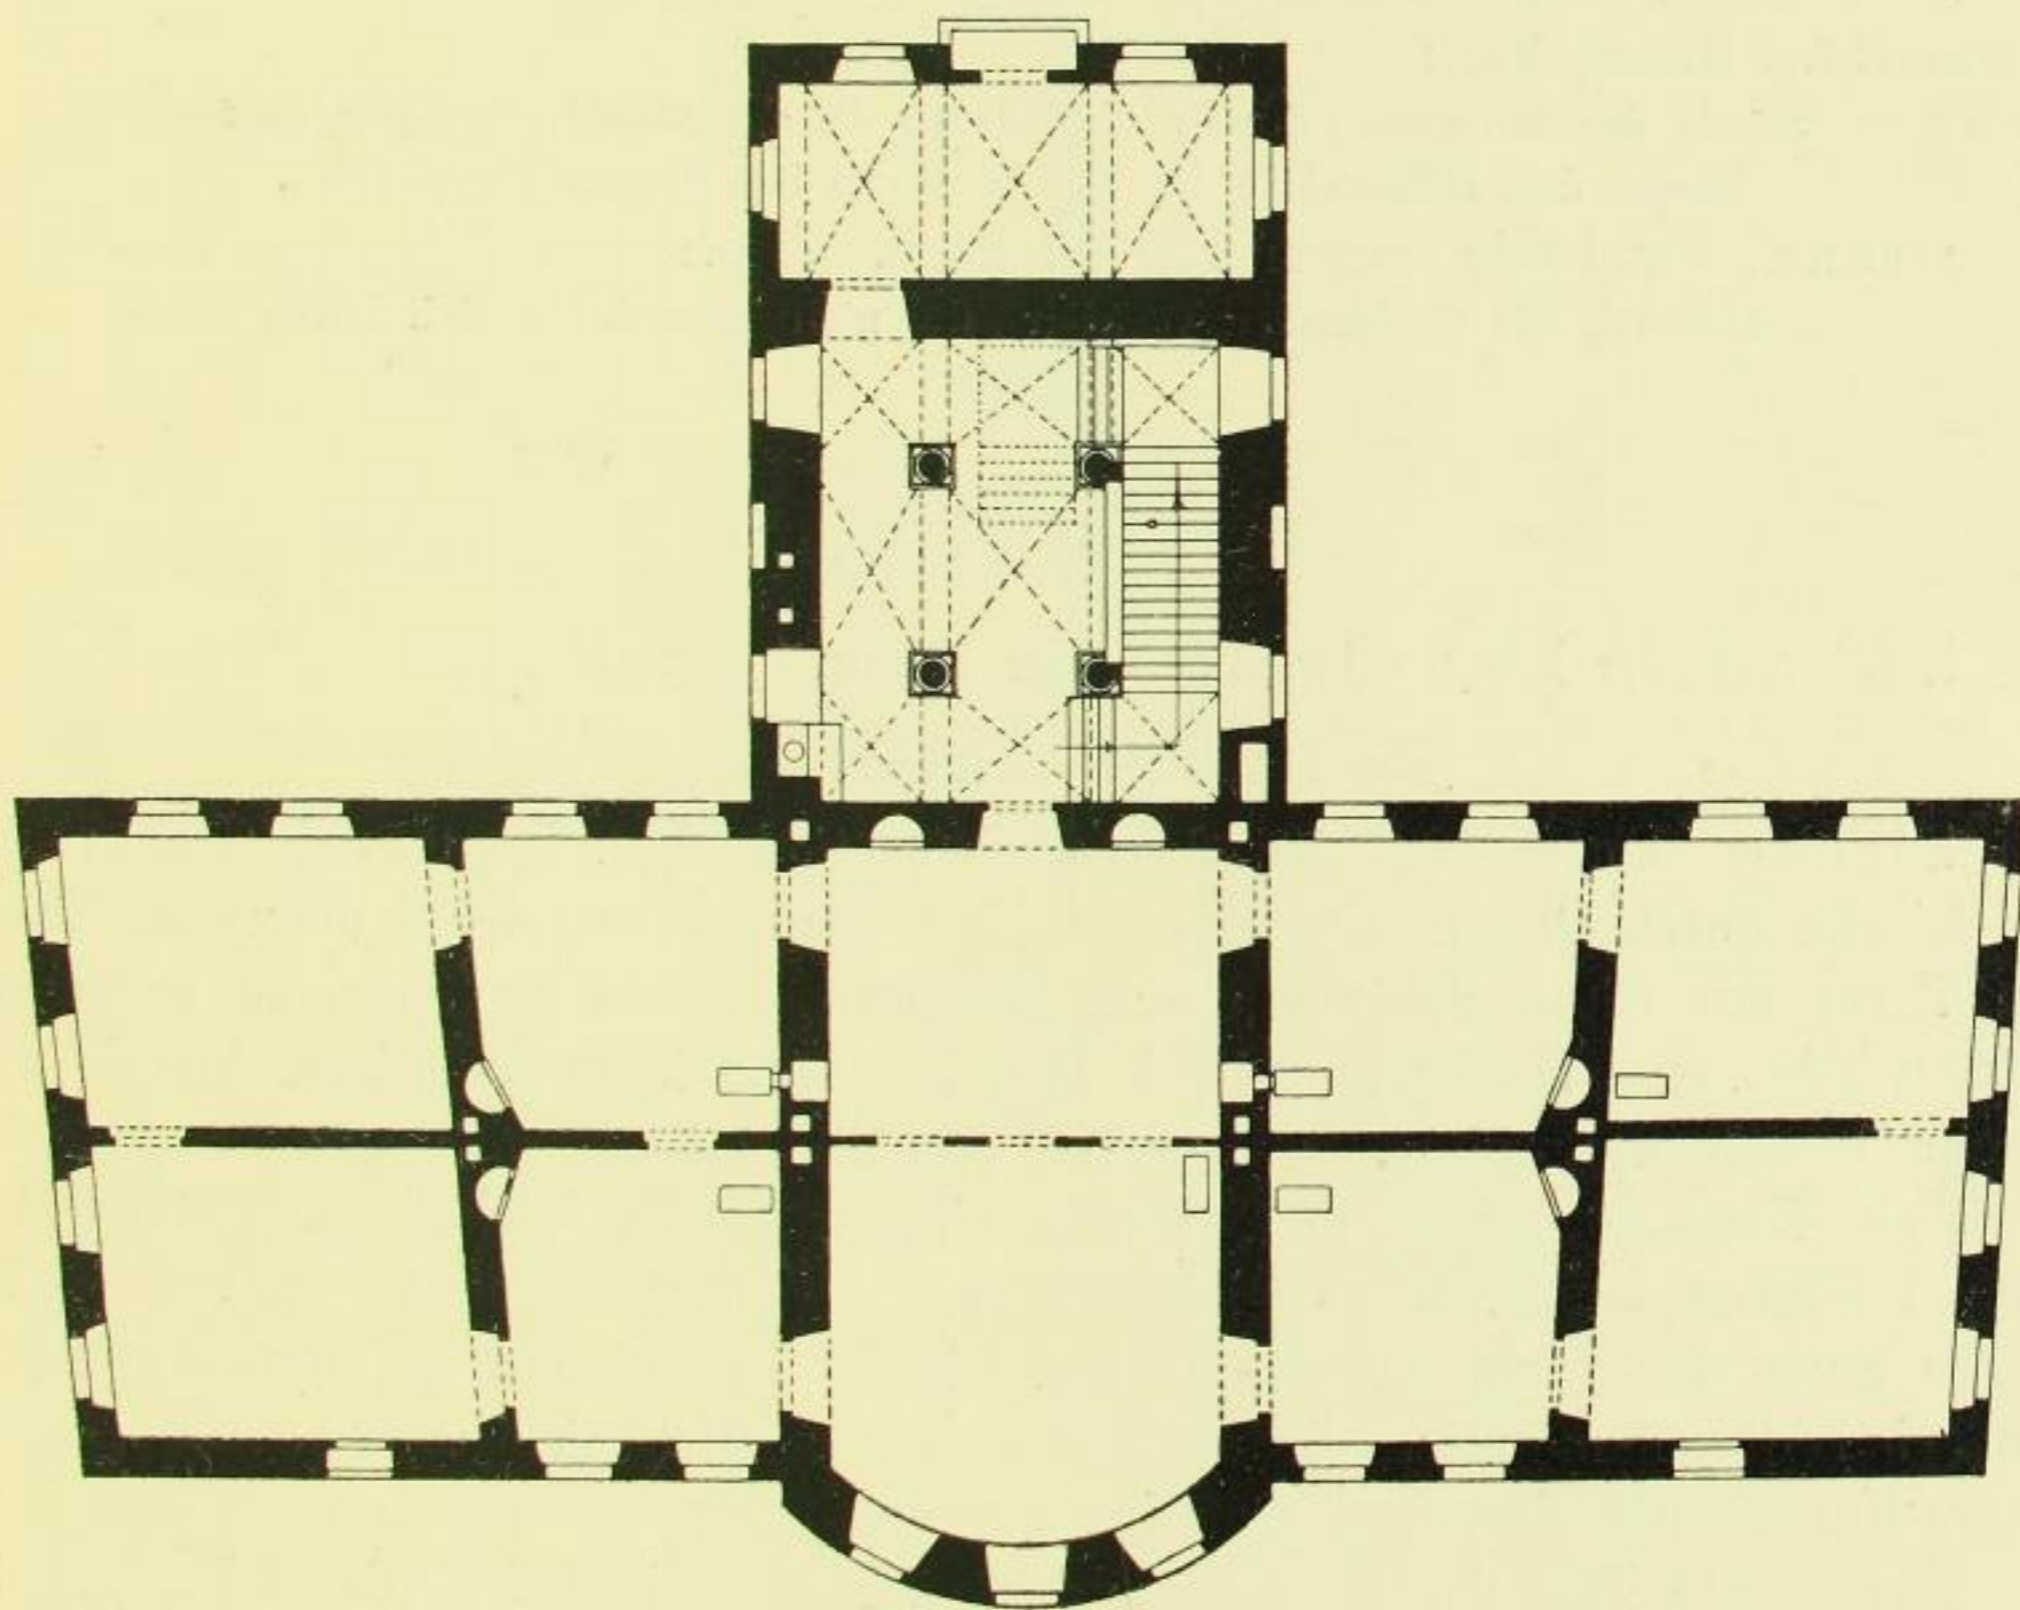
Hainewalde, Schloß, Grundriß des Obergeschoßes.
